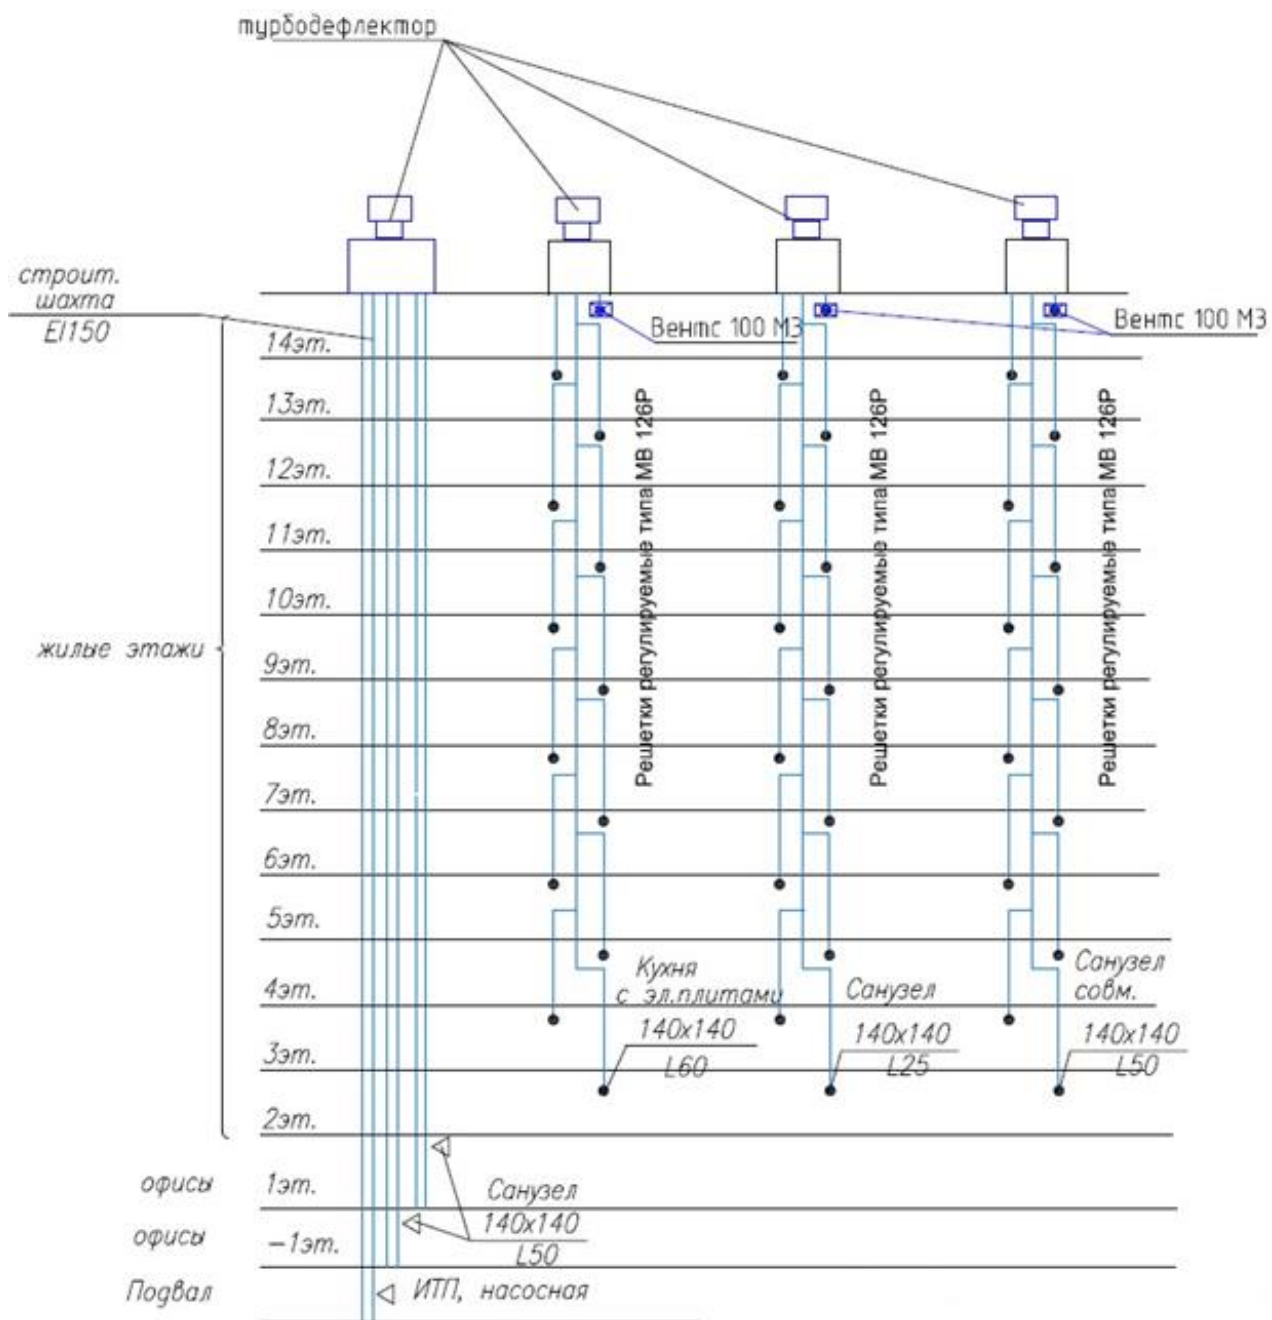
Принципиальная схема систем вытяжной вентиляции с выбросом на кровлю
